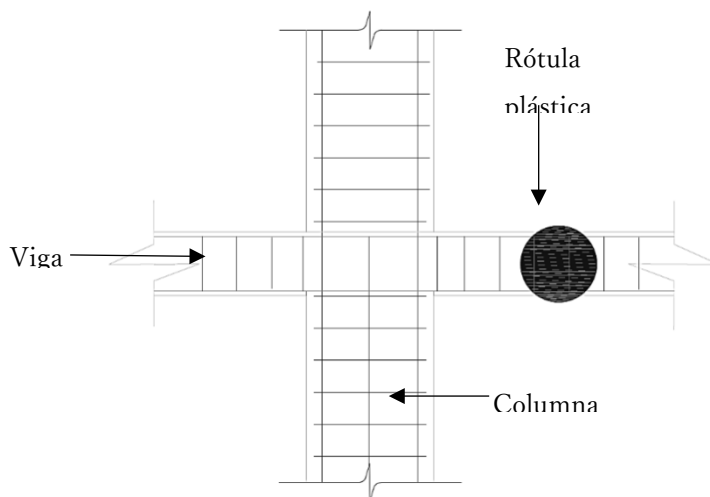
Vista lateral de un nudo viga – columna y la rótula plástica en la viga
